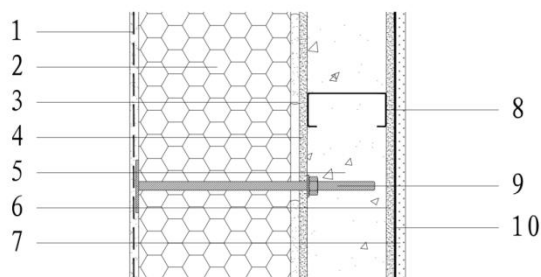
薄抹灰系统预制墙体构造示例
